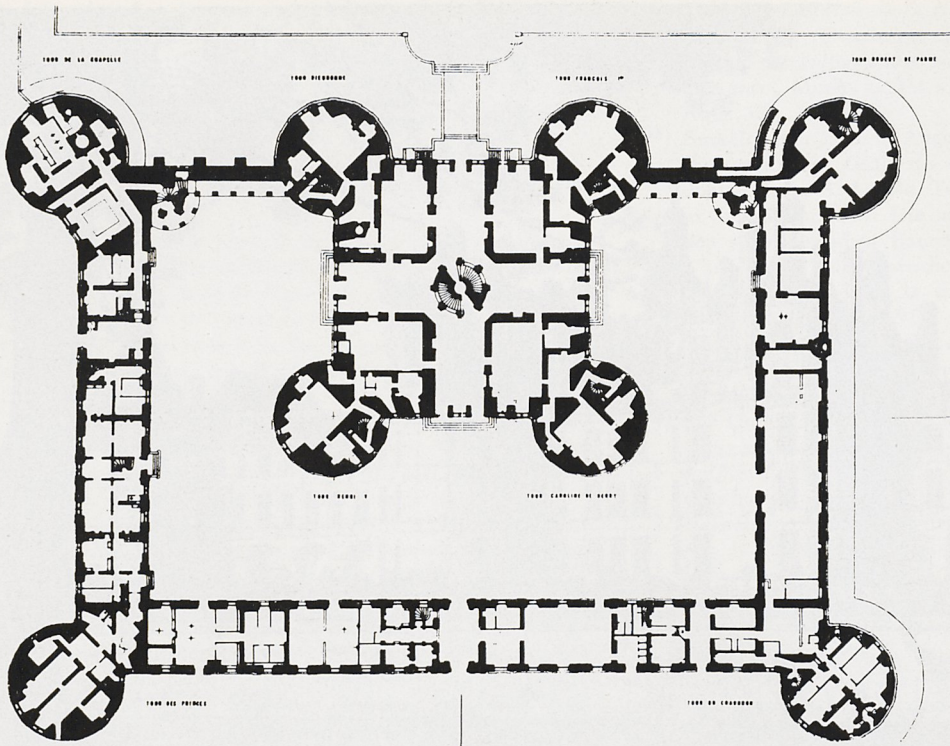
Chambord, Grundriß. Plan von Michel Ranjard.
